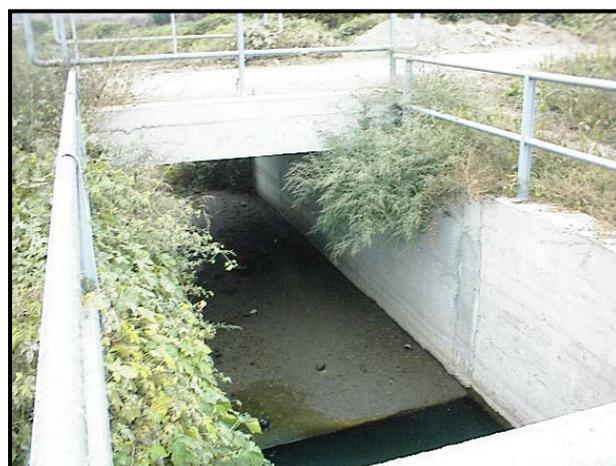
Vista verso monte dell'attraversamento stradale, presente circa 100 m a valle delle paratoie.
